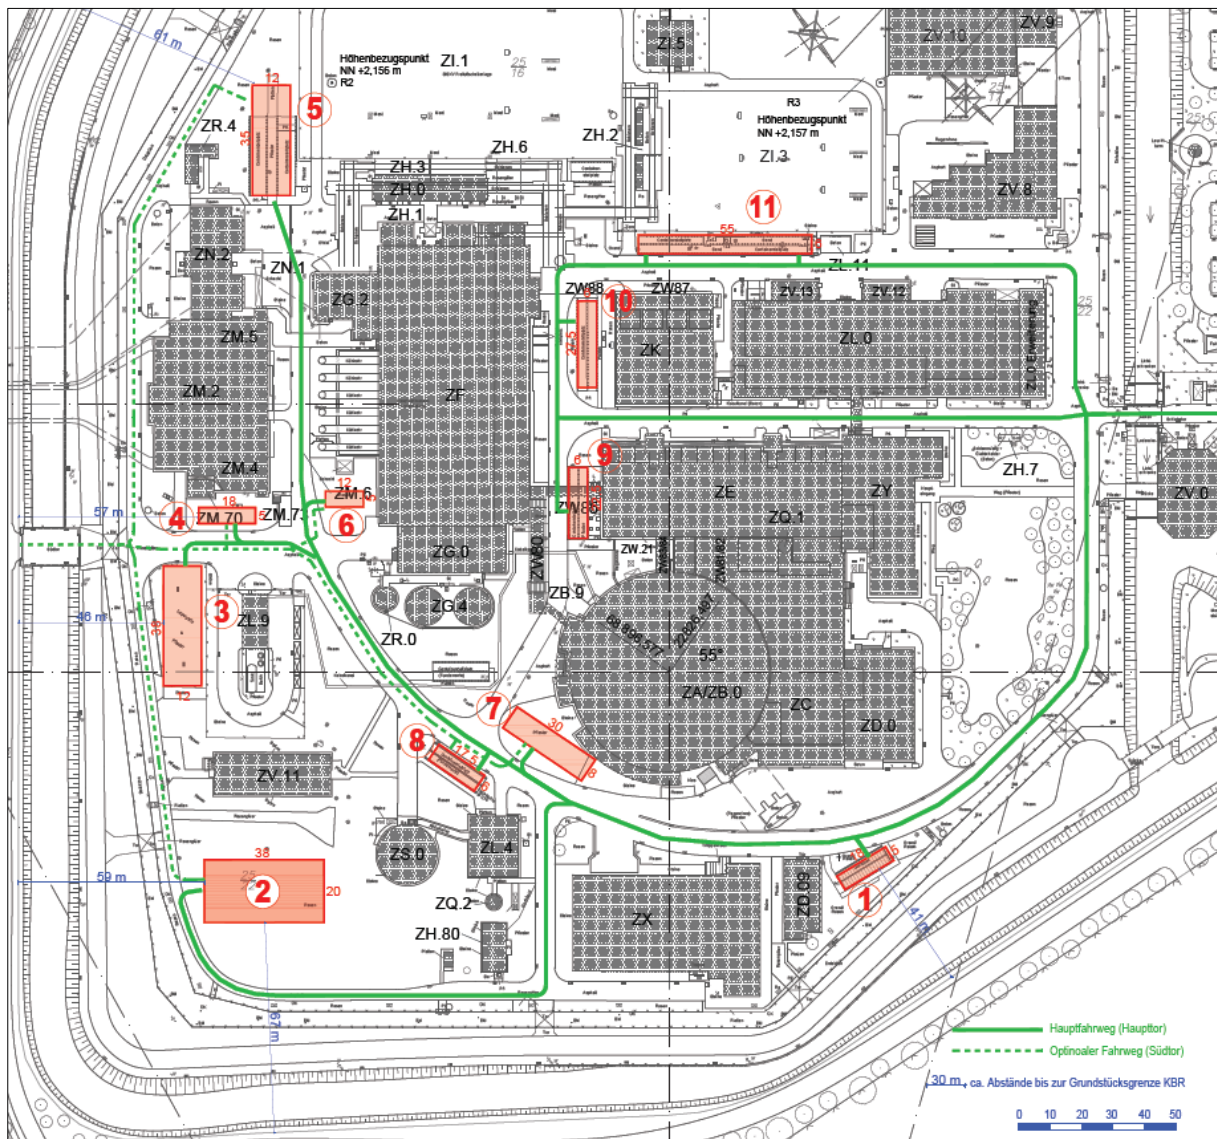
Lage der potentiellen Pufferlagerflächen (rot gekennzeichnet mit Nummern 1 bis 11)
